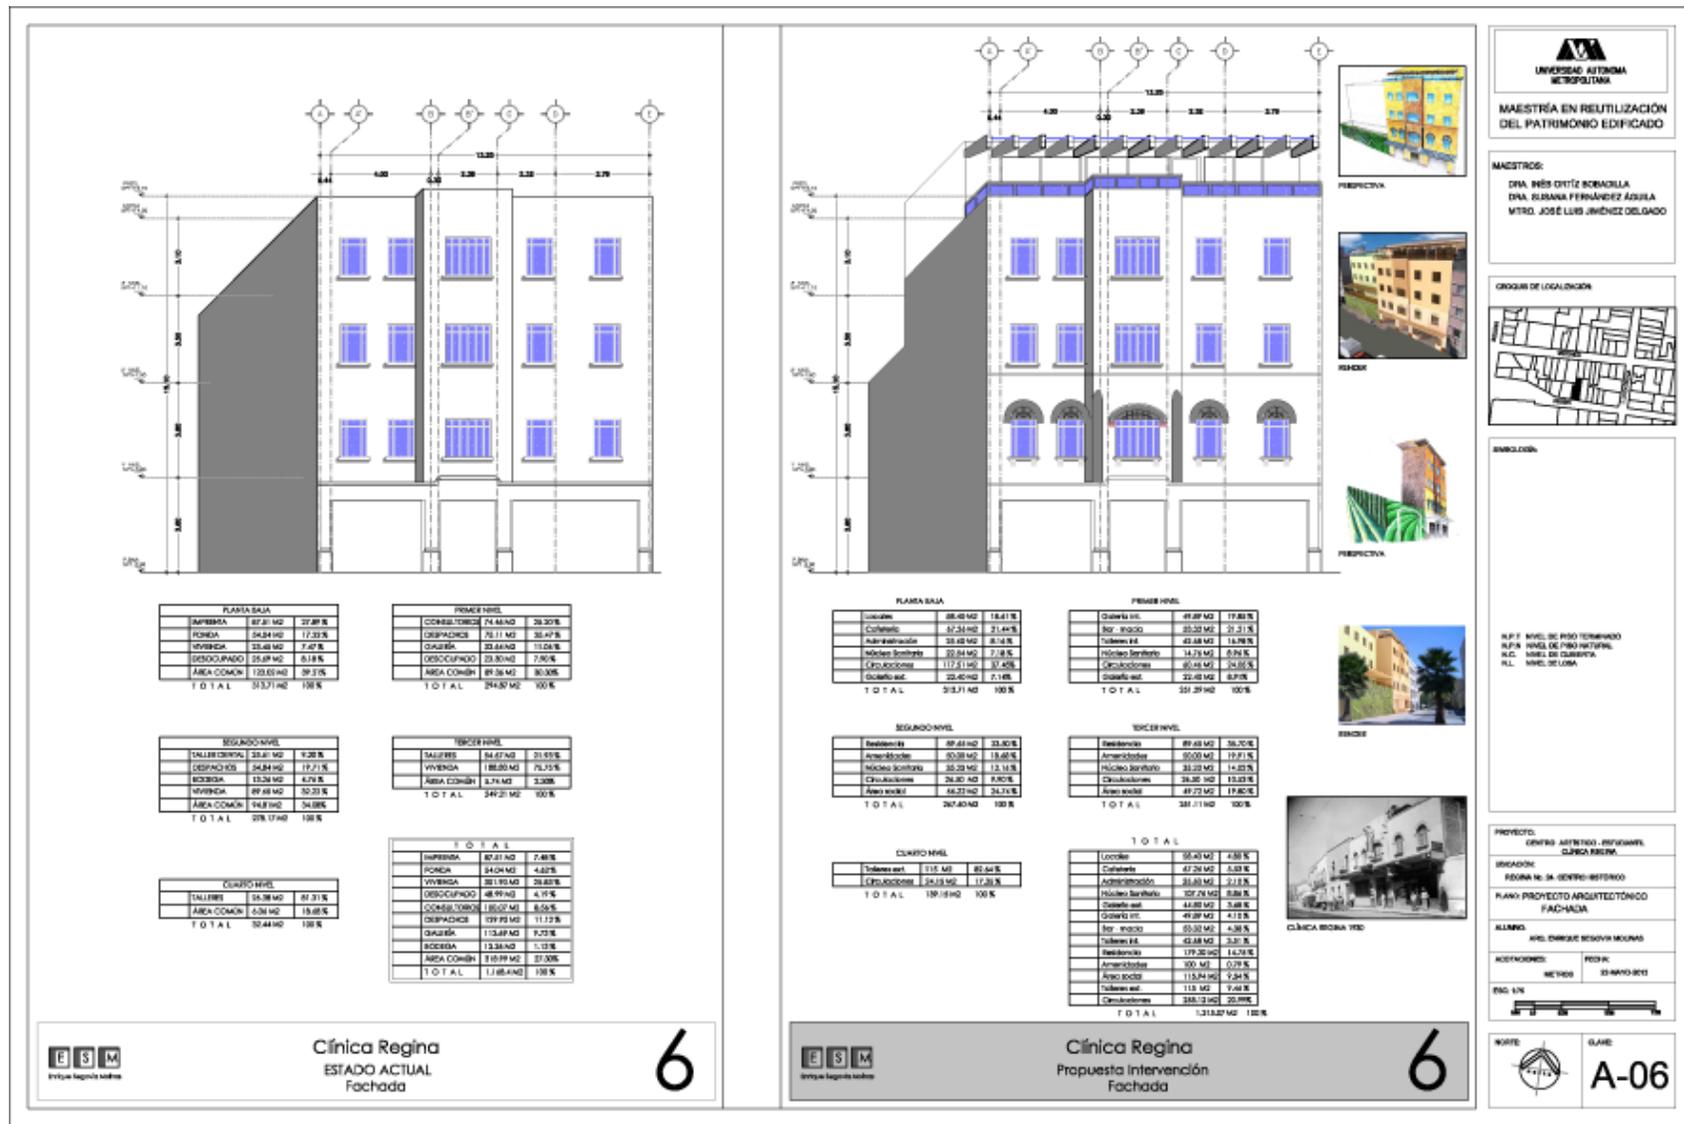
Estado actual y propuesta. 4° Nivel y Fachada.
